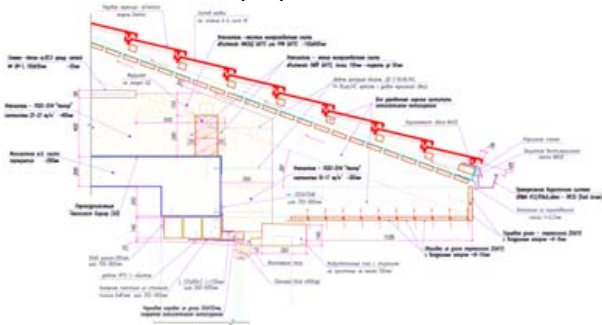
Примыкание чердачного перекрытия и наружной стены
